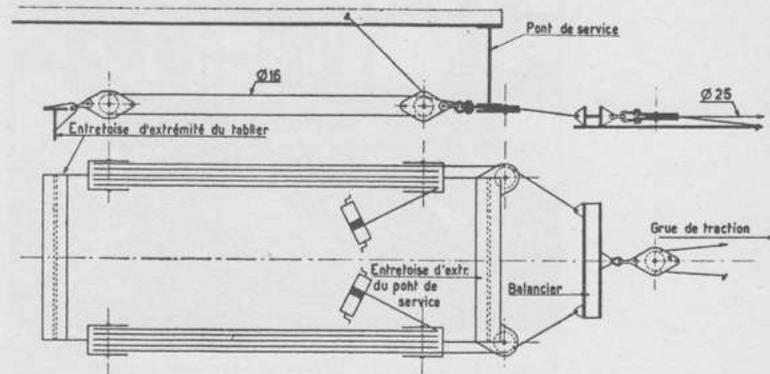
Elevation et plan des câbles de traction pour le lancement du pont de service.
